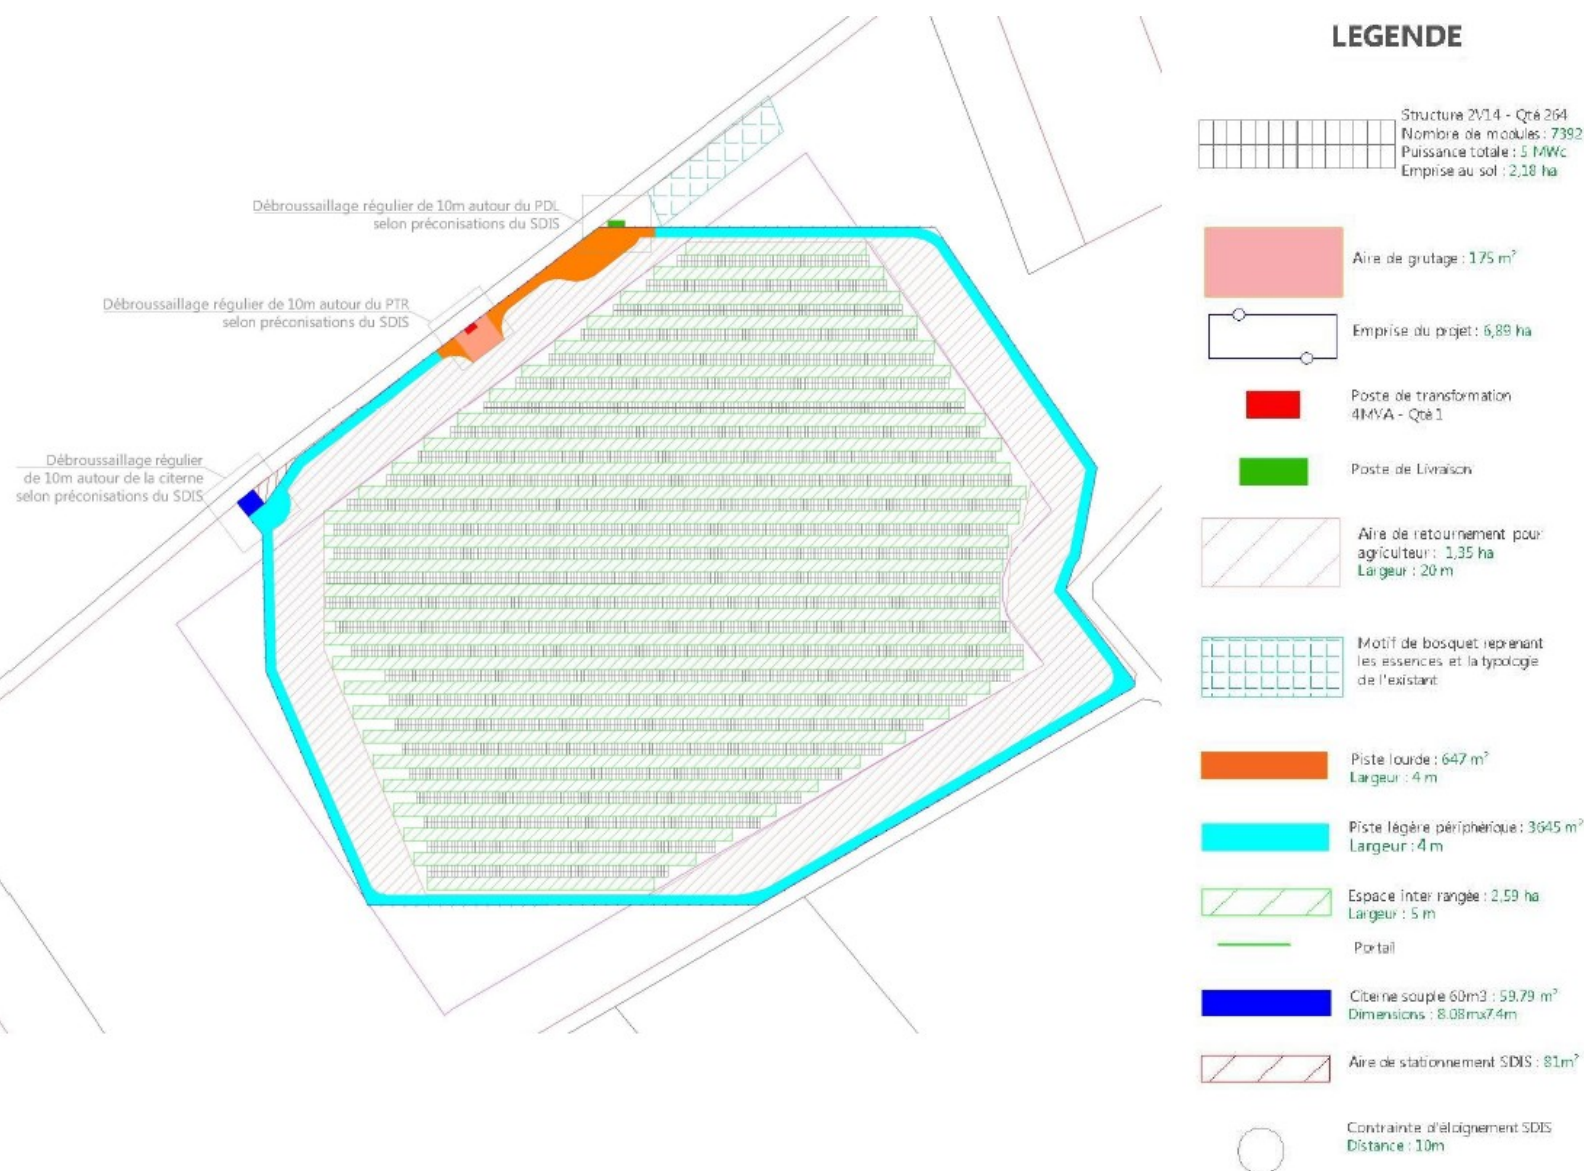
plan d'implantation du projet (source : résumé non technique, page 11)
